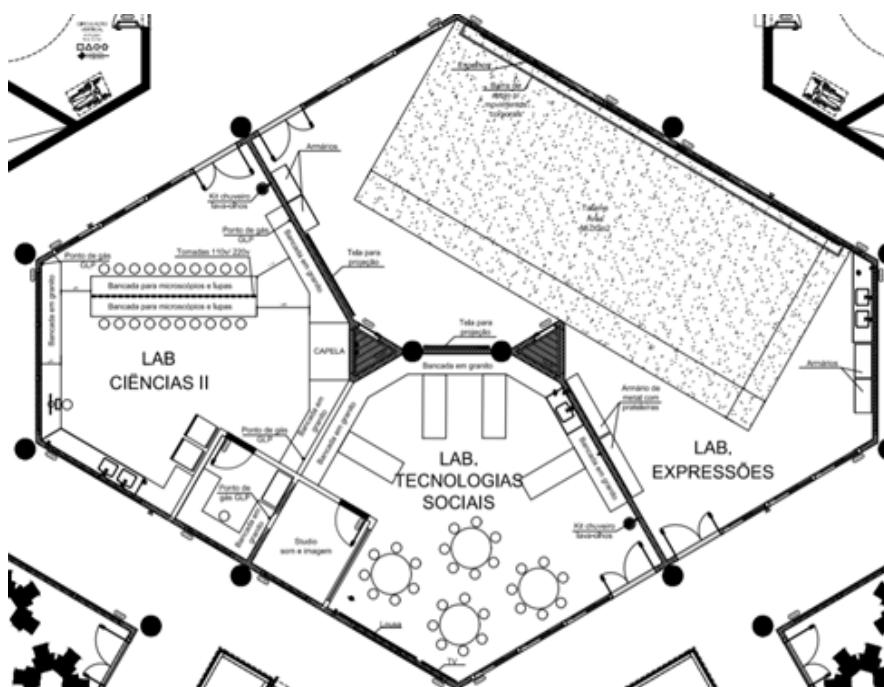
Planta laboratórios pavimento 1 (Bloco Pedagógico).
